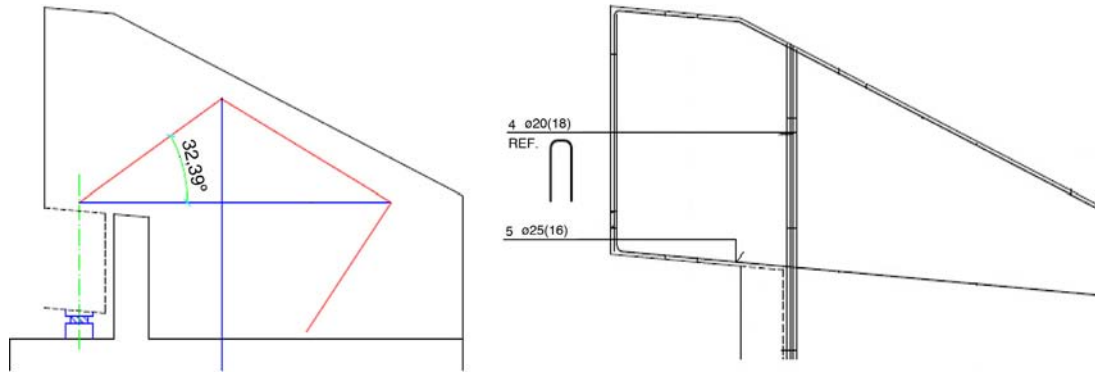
Modelo de bielas y tirantes del estribo y armadura equivalente.
